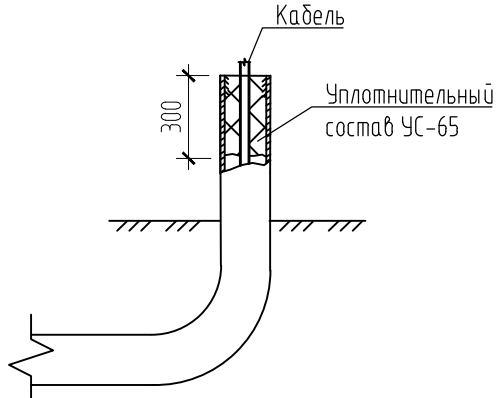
Заделка концов водогазопроводных труб после прокладки кабеля
